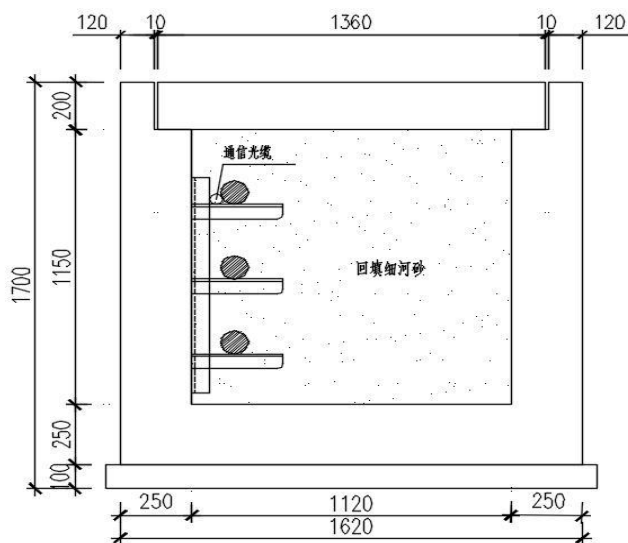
单回路电缆沟（新建段）敷设断面图
